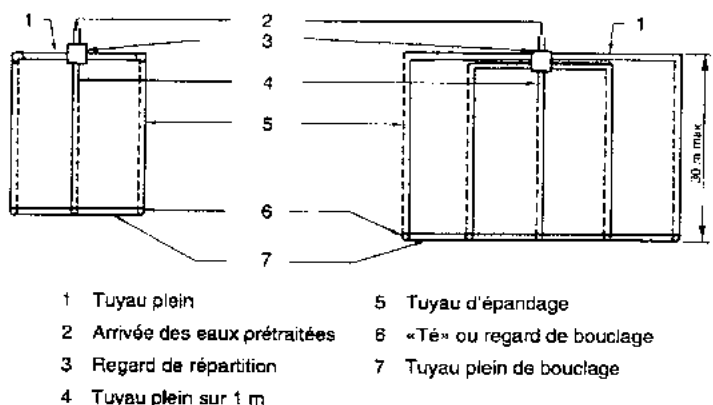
Vues en plan ; exemples à 3 et 5 tranchées
